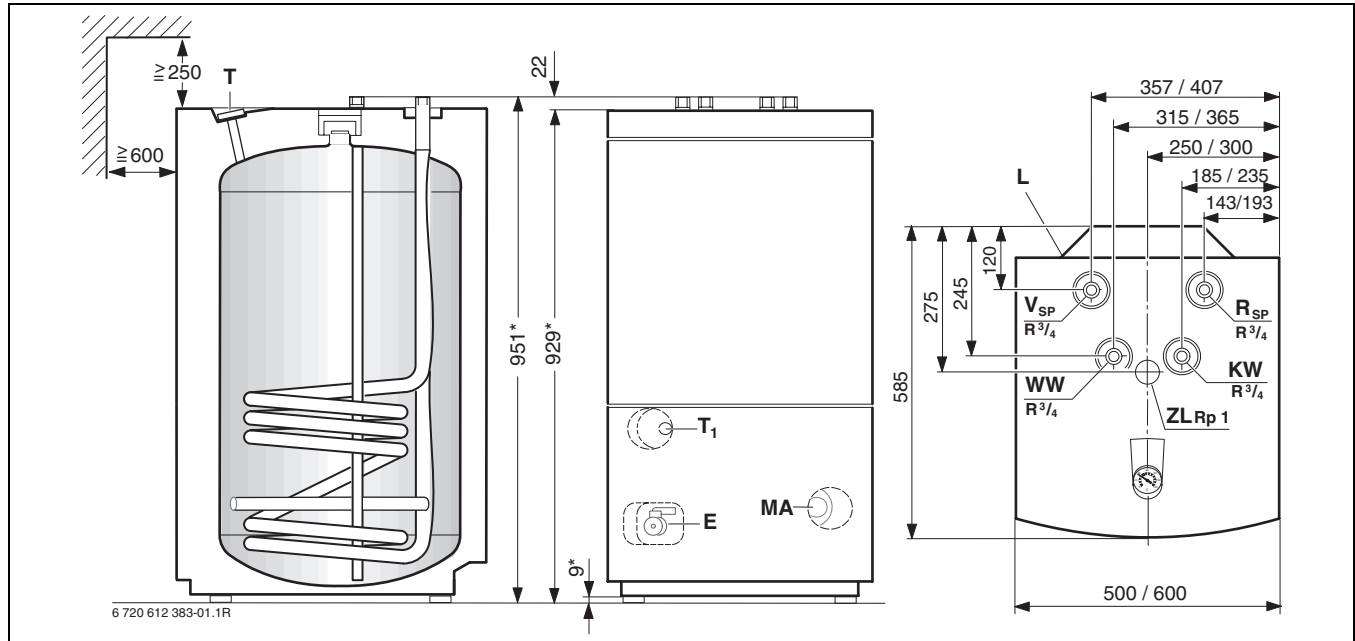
Bau- und Anschlussmaße ST 120-2 E. und ST 160-2 E. (Maßangaben hinter einem Schrägstrich beziehen sich auf die größere Speicherausführung)
